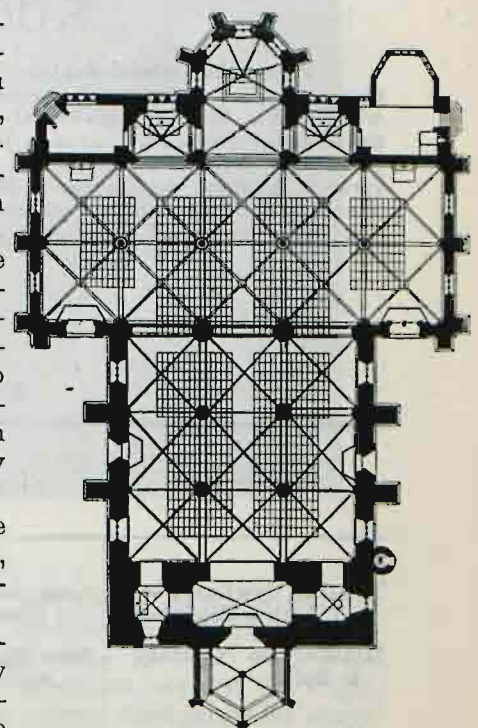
Plan kościoła w Lubczycach przed powiększeniem.
